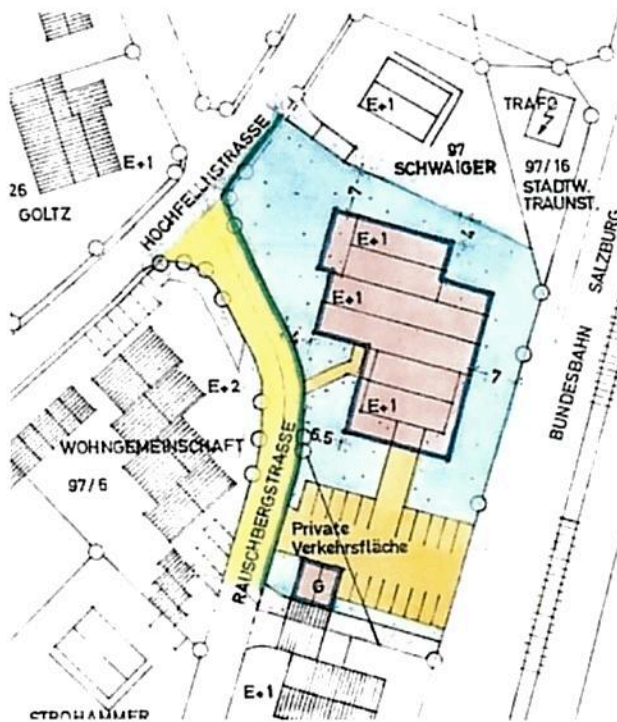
Auszug Bebauungsplan Oberhaid, Quelle: Stadt Traunstein
